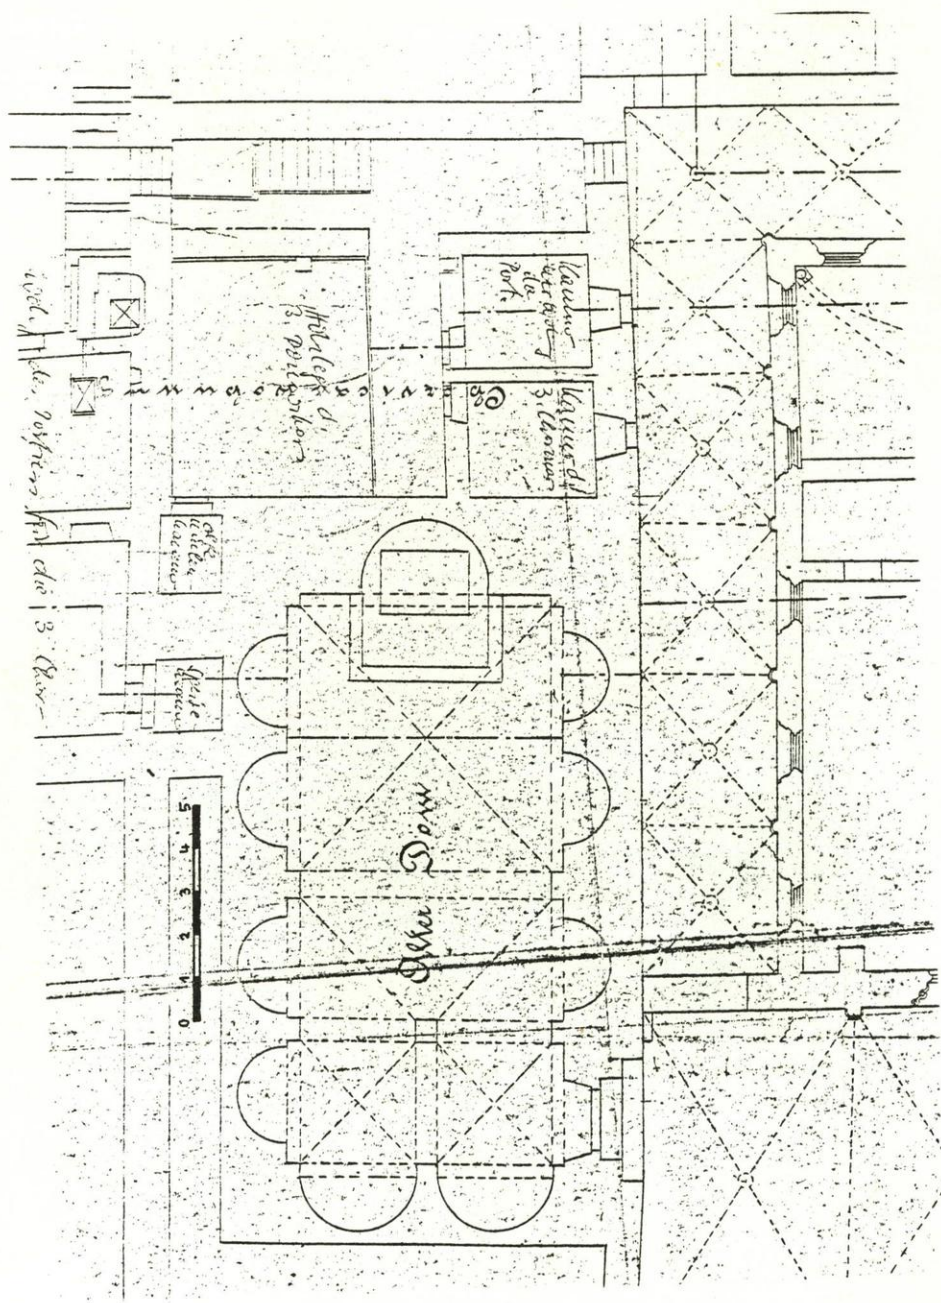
Grundriß des Quadermauerhauses im Parterre (Plan aus der Abteilung „Domkreuzgang“ im Landbauamt, datiert 1860).
